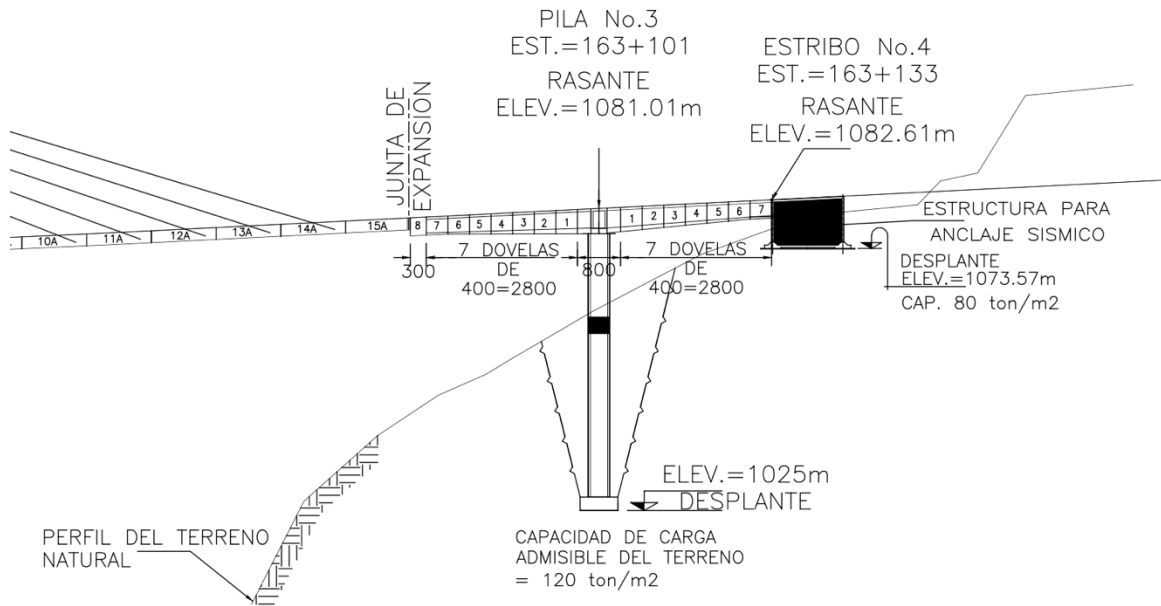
Vista de perfil del tablero principal y la Pila No. 3
